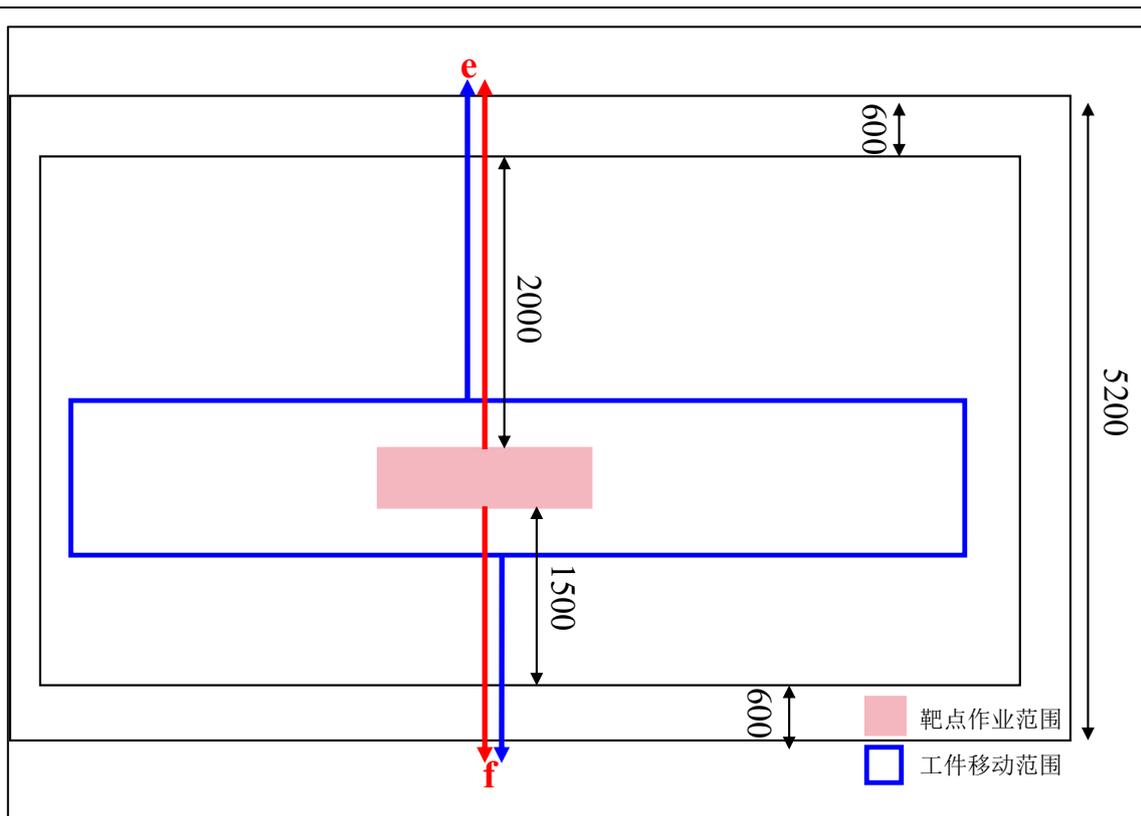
本项目探伤室剖面布局与预测点位图 (单位:mm)
